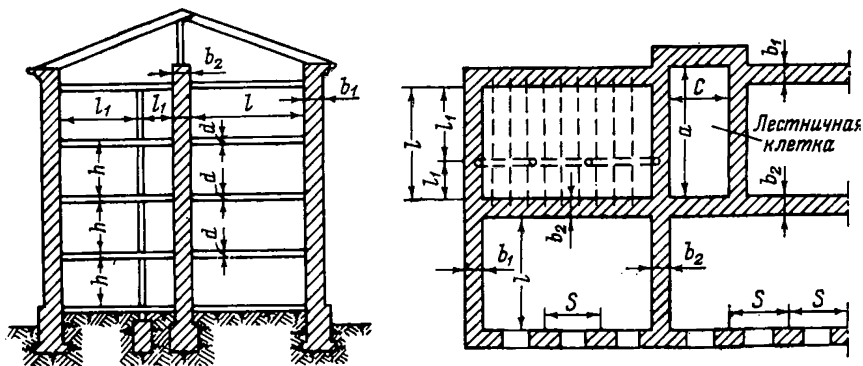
Схематический план и разрез жилого дома с обозначением основных параметров конструктивных элементов капитально ремонтируемых жилых зданий
